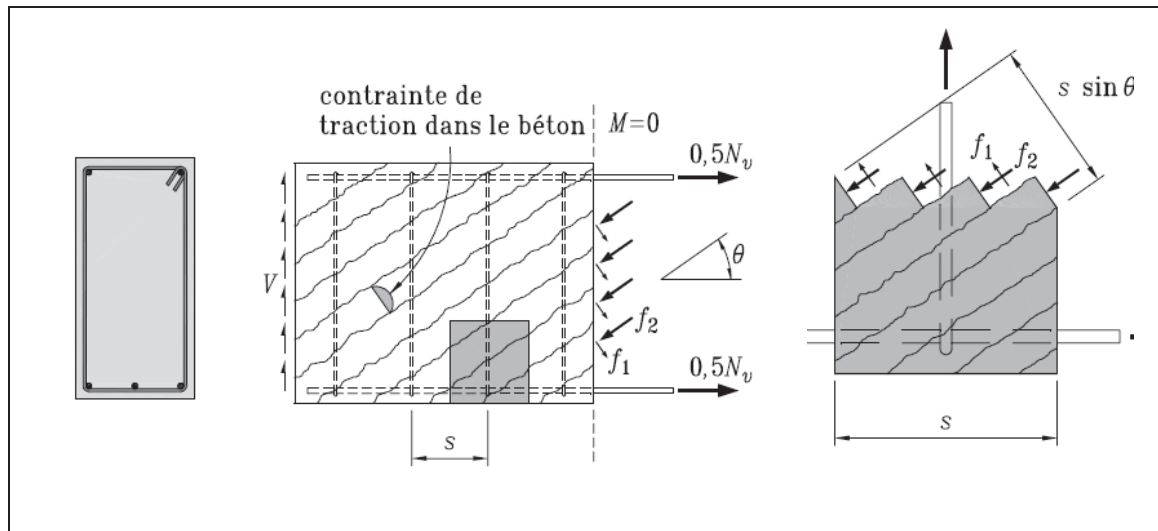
Équilibre d'une section de béton soumise au cisaillement
